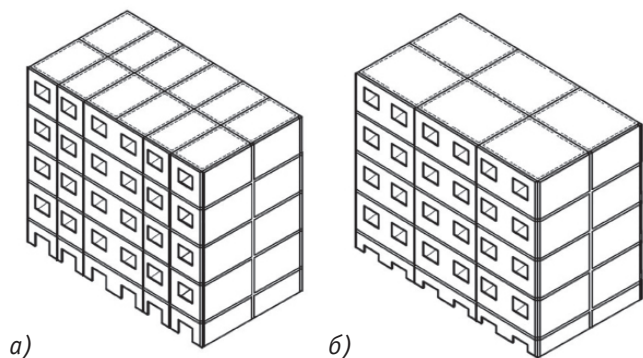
Конструктивная схема крупнопанельного здания: а) с узким шагом поперечных стен; б) с широким шагом поперечных стен
